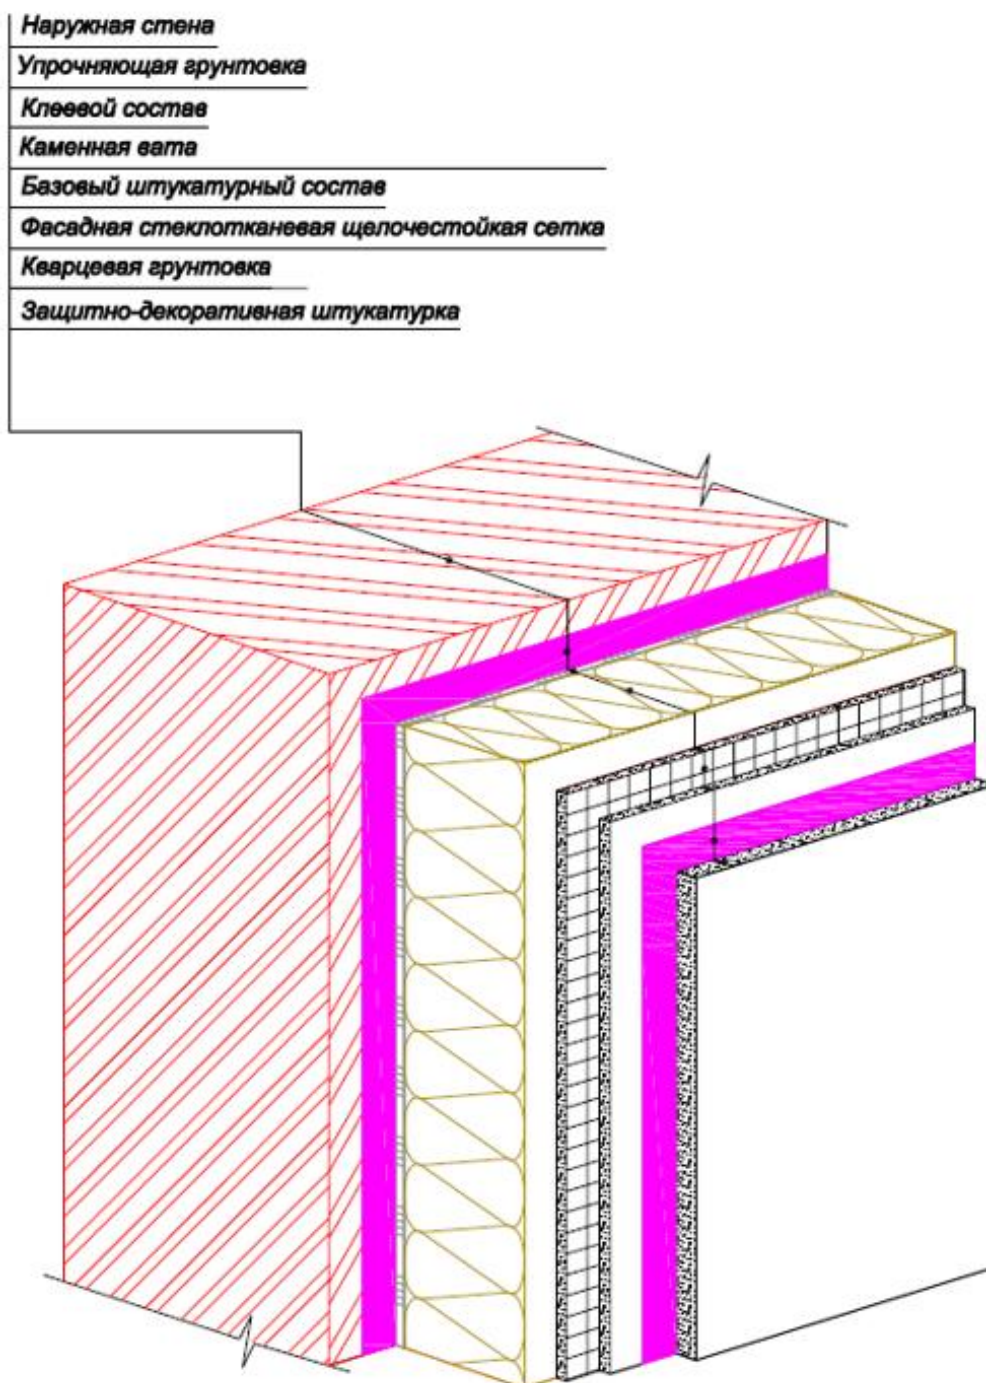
Теплоизоляционная штукатурная конструкция
